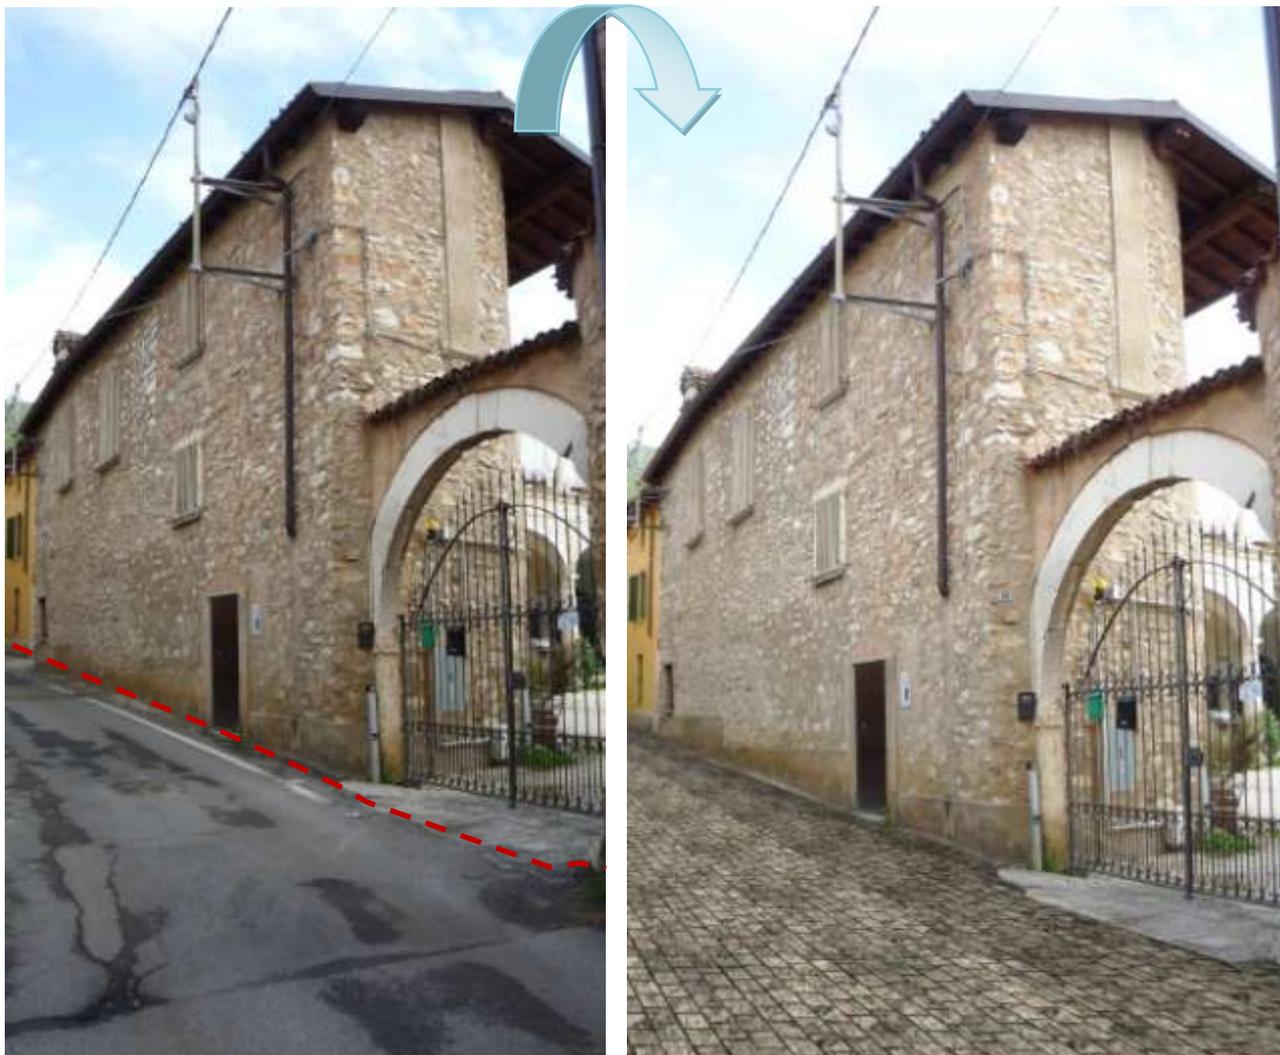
Via Foina (Stato di fatto-Stato di progetto)
